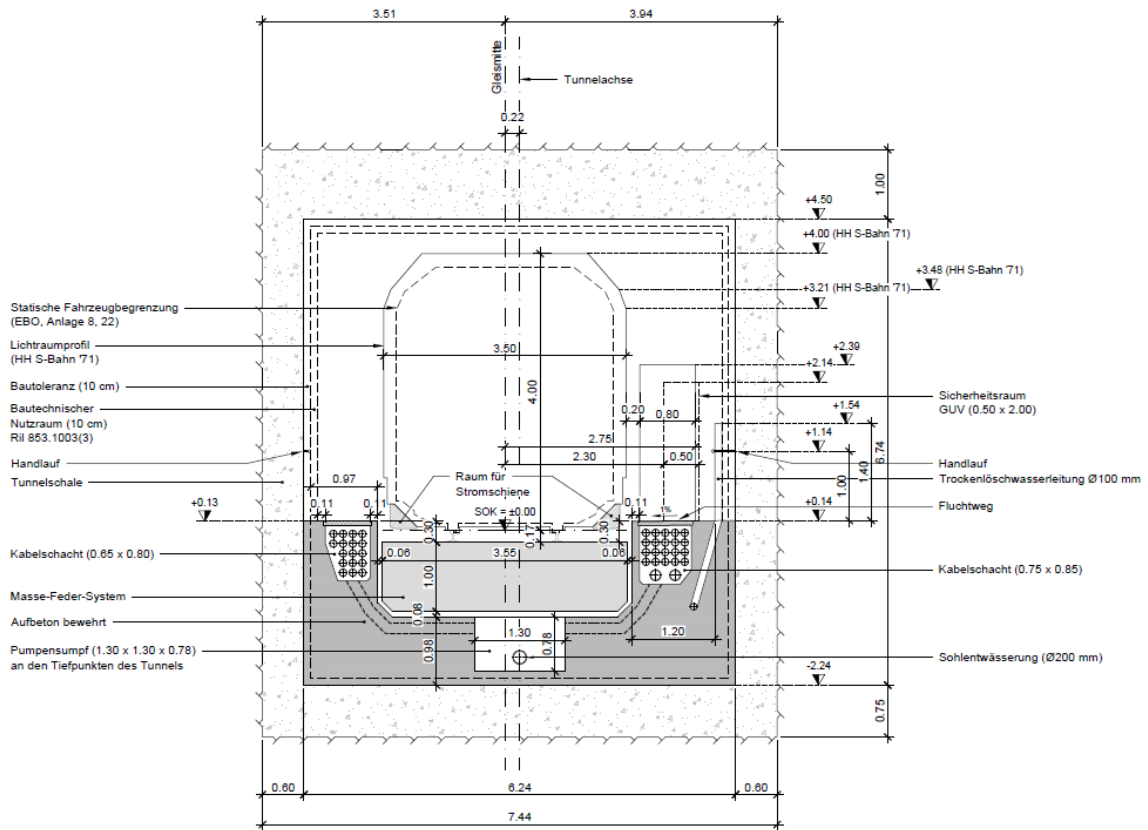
Regelquerschnitt Tunnel Offene Bauweise einspurige Gleisführung
